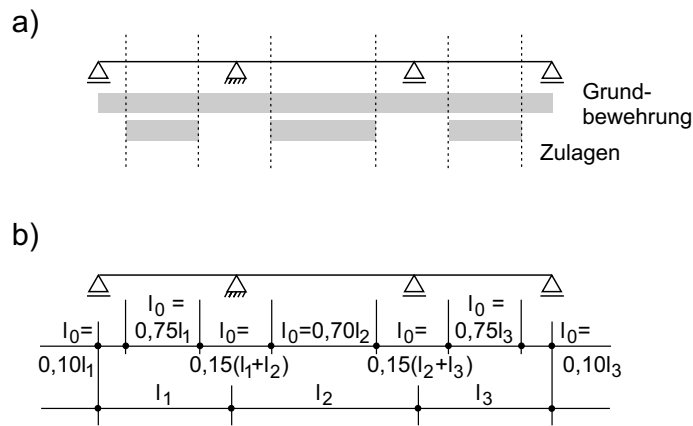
Anordnung der Grundbewehrung und der Zulagen der Biegebewehrung am unteren Querschnittsrand a) nach dem Verfahren der typisierten Bewehrungsverteilungen b) entsprechend der Lage der Momentennulldurchgänge nach DIN 1045-1 [19]
